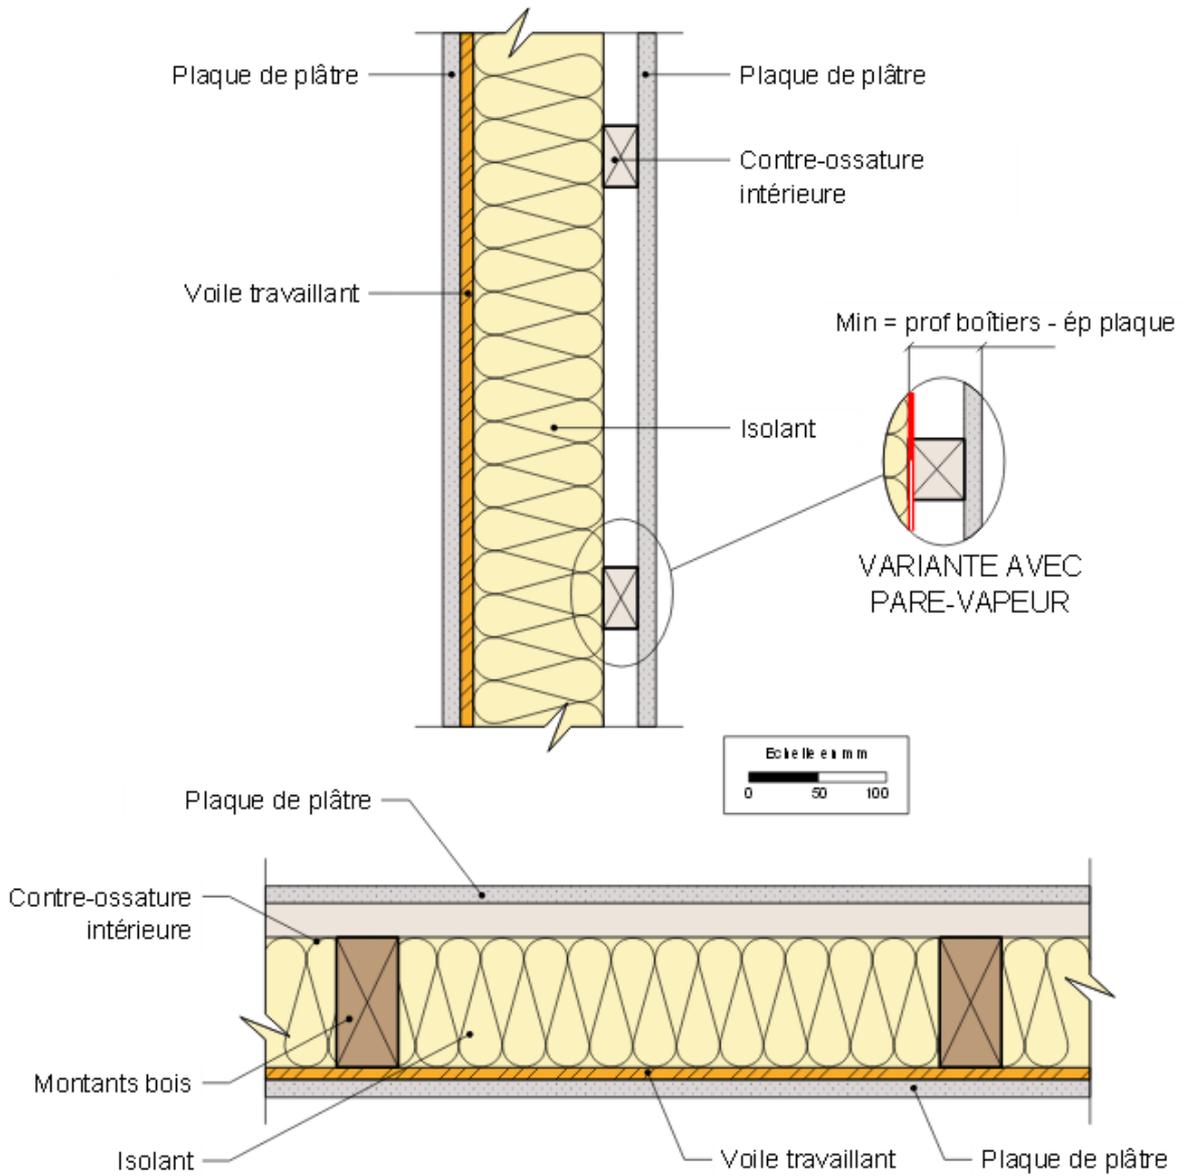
Contreventement sur une face et pose directe du parement sur le voile de contreventement (coupe verticale en haut, verticale en bas)
